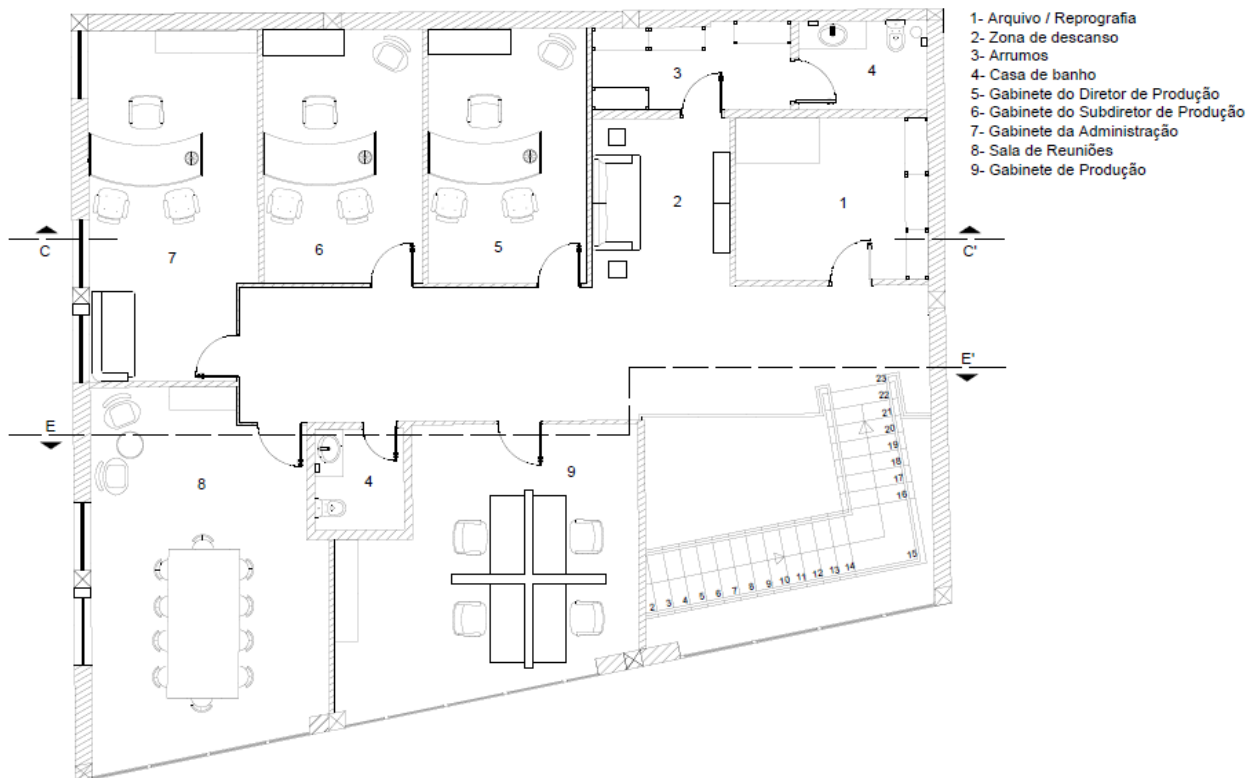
Planta Piso 1. Fonte: Ana Cândido.
